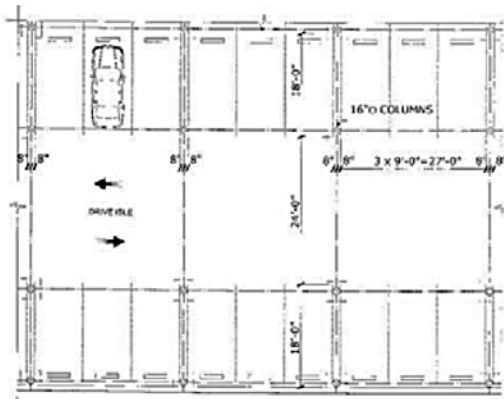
План паркинга с малыми пролетами (Short-Span Parking Structures) [10]
